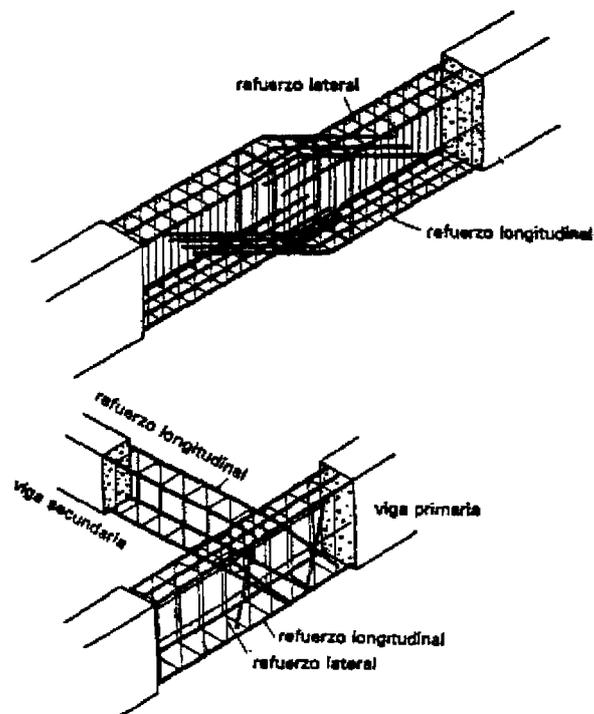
Detalle de refuerzo en viga con desnivel y del apoyo de una viga secundaria en una primaria
